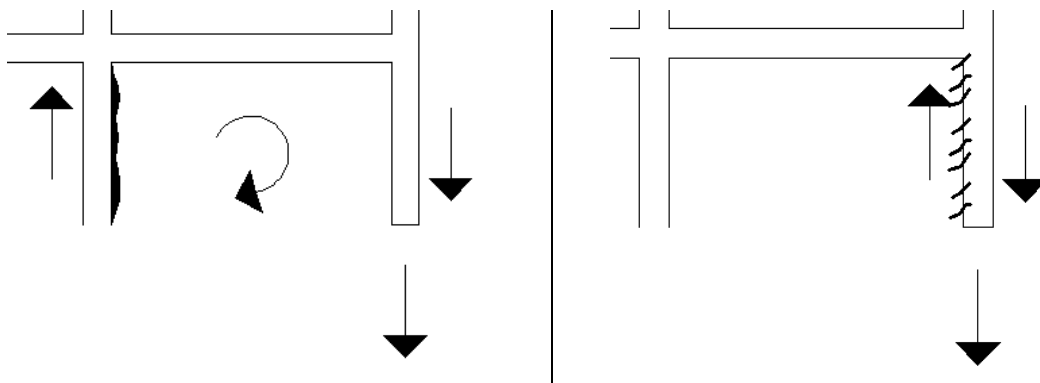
Tensões tangenciais pilar/parede. No primeiro caso fissura única; No segundo caso fissuras a 45° (Modificado, Ortiz, 1983).
